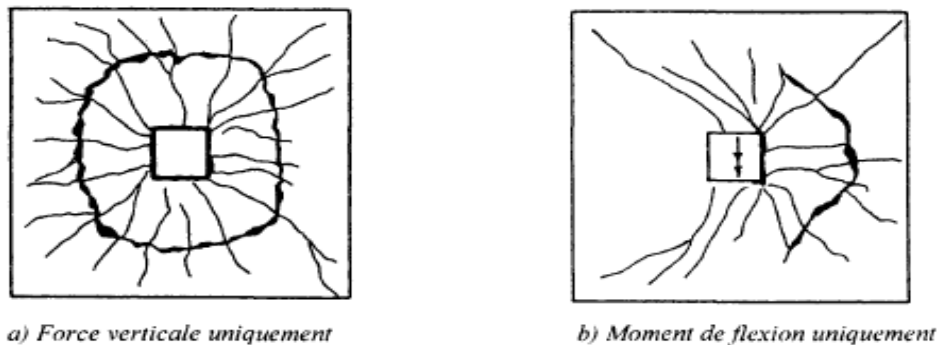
Etat de fissuration et fissures de poinçonnement à la rupture (vue en plan de la dalle)[23].
